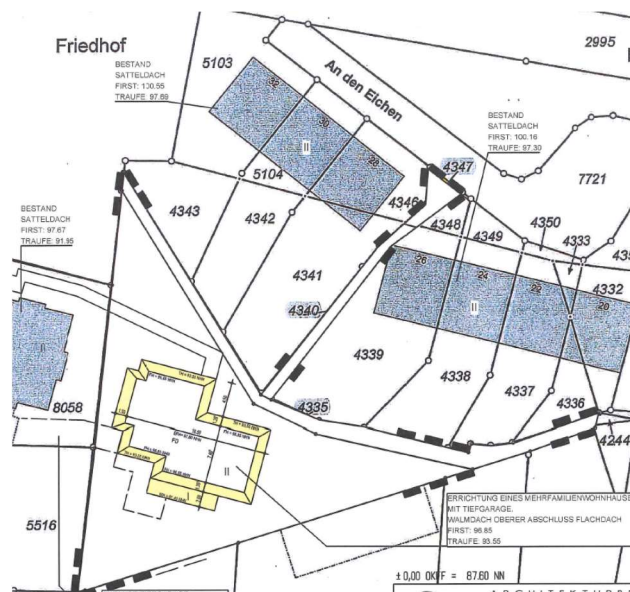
Lageplan mit Darstellung des geplanten Wohngebäudes (ohne Maßstab)
